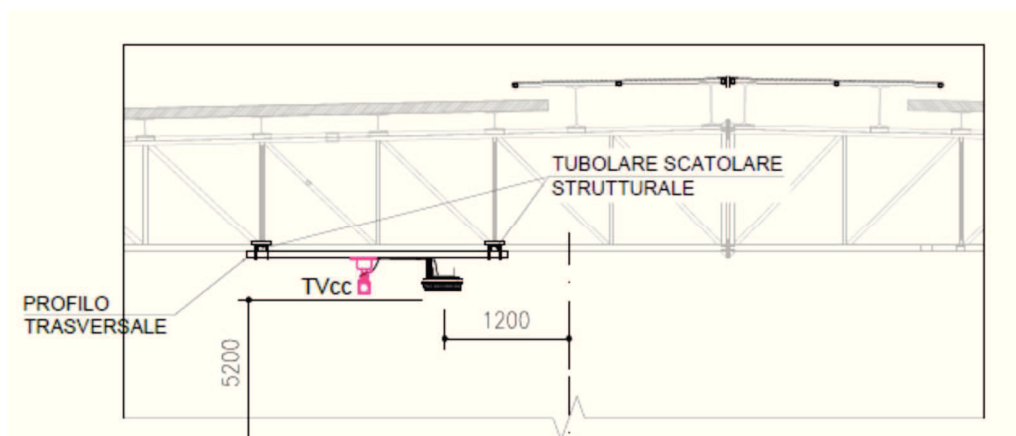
Dettaglio profilo trasversale fissato alla struttura della galleria
